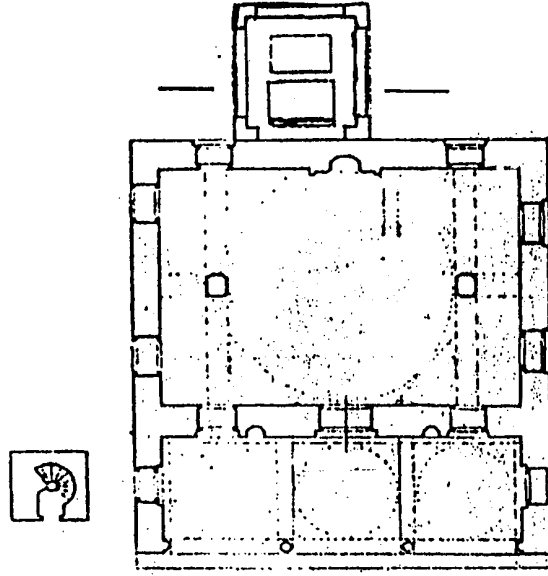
مسقط أفقي للجامع العتيق (اسكي جامع)
